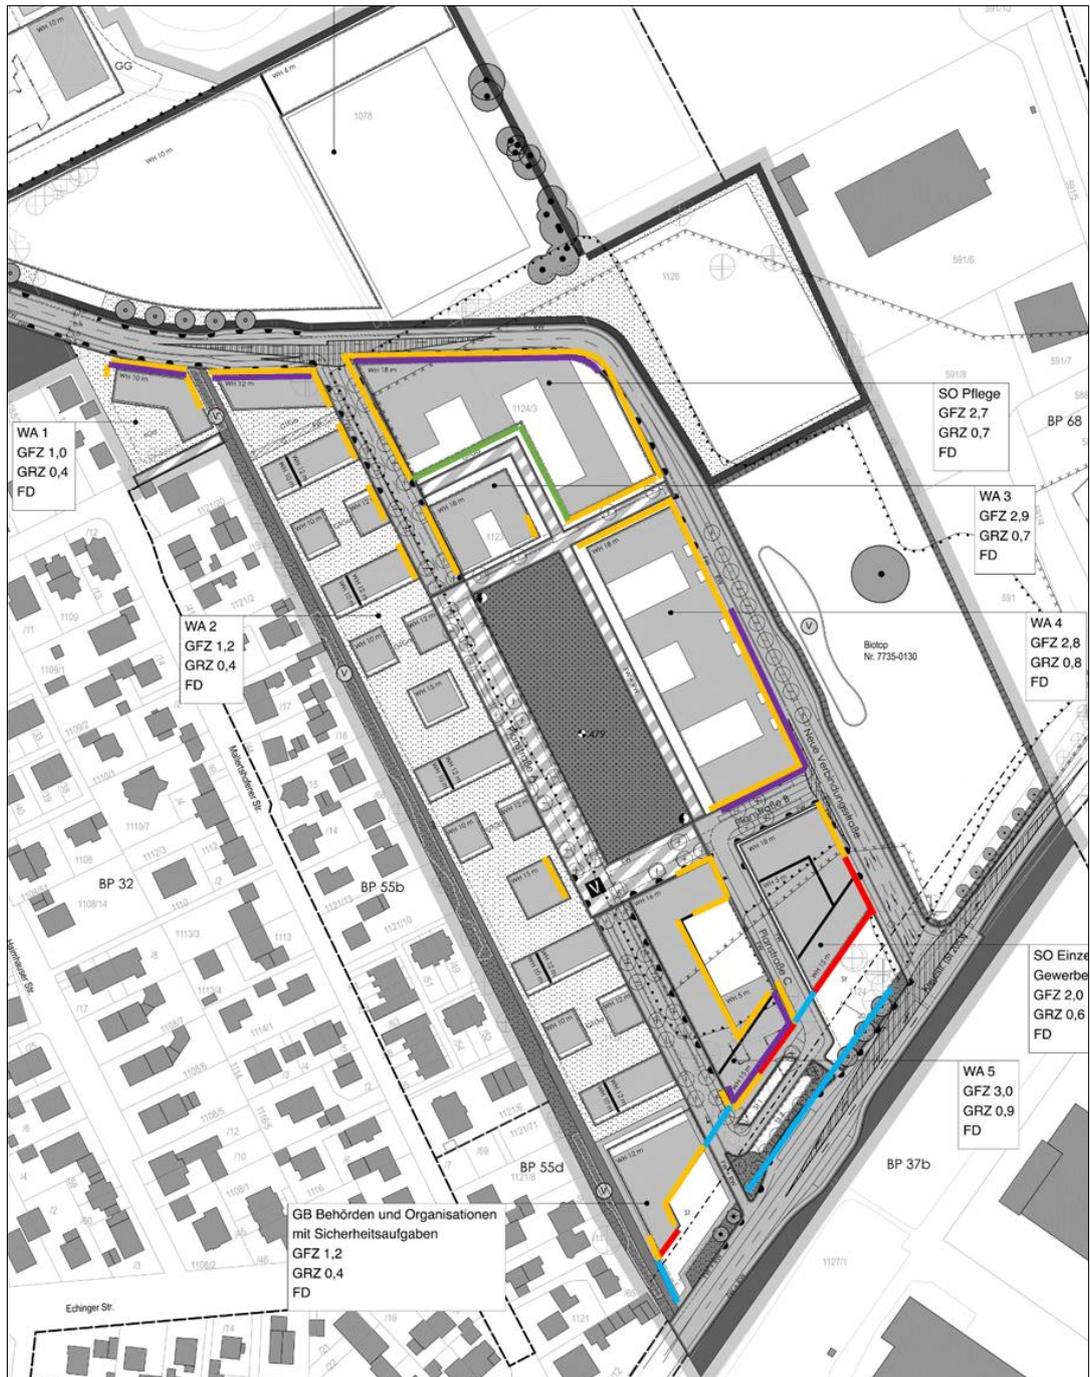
Fassadenkennzeichnung für die Vorschläge für Festsetzungen zum Bebauungsplan.
